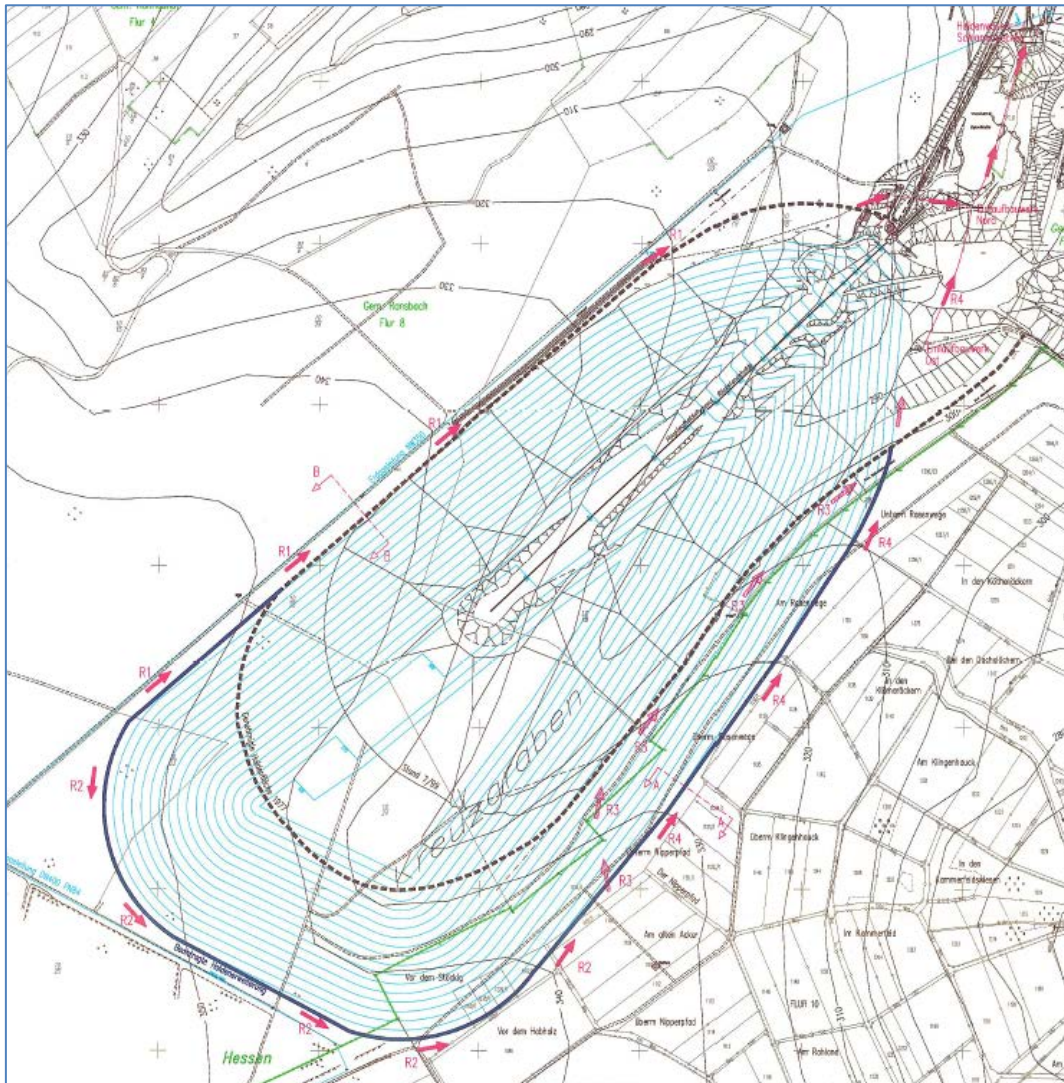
Lageplan Haldenerweiterung Haldenwassergräben R1, R2, R3, R4 (Anlage B-7 des RBP HA-19/99)
